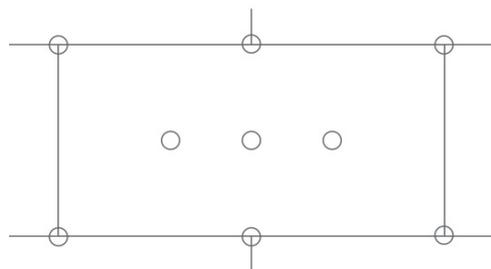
Panneaux ECOROCK, 431 IESE et ISOVER TF de dimensions 1200 x 600 mm - plans de chevillage en plein (espacement entre chevilles \geq 150 mm)
